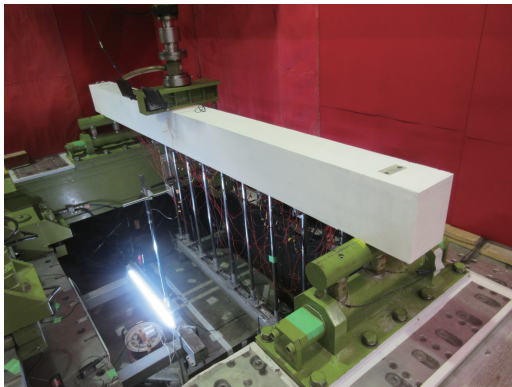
静荷重載荷時の実験装置と試験体の設置状況
